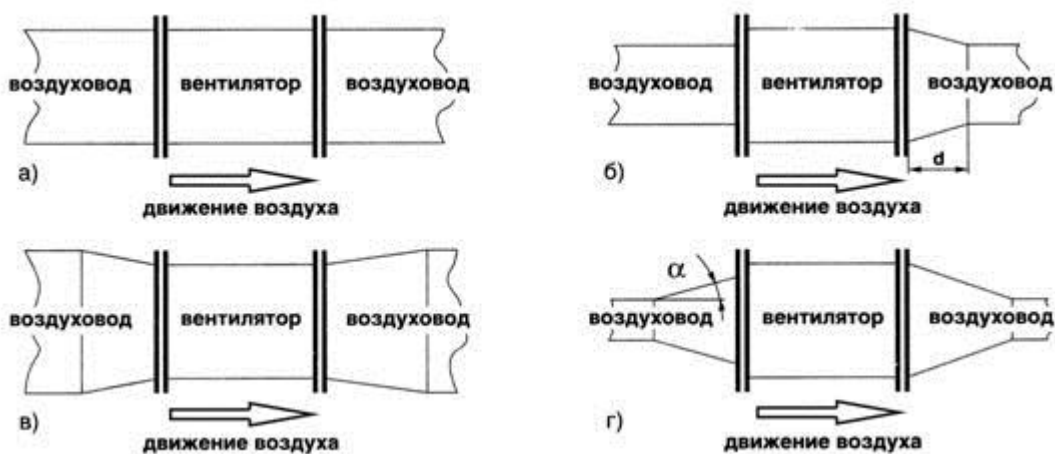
Соединения вентилятора ВК 11 с воздуховодами квадратного и прямоугольного сечения произвольных размеров
